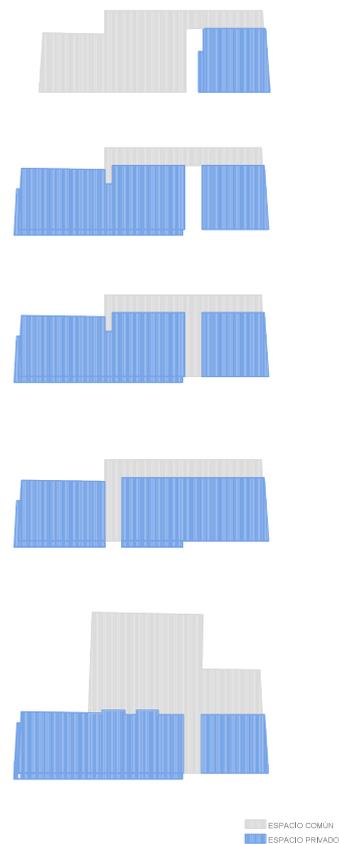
Relación espacios comunes respecto a espacio privado en cada planta desde planta baja.
